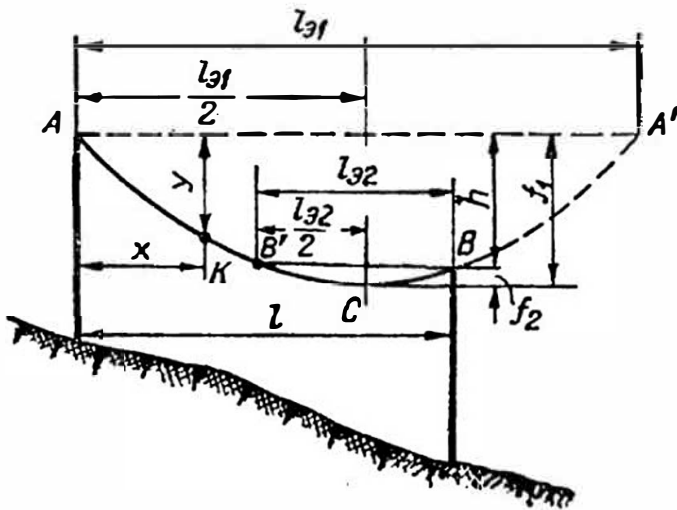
К расчету проводов с разной высотой точек подвеса
